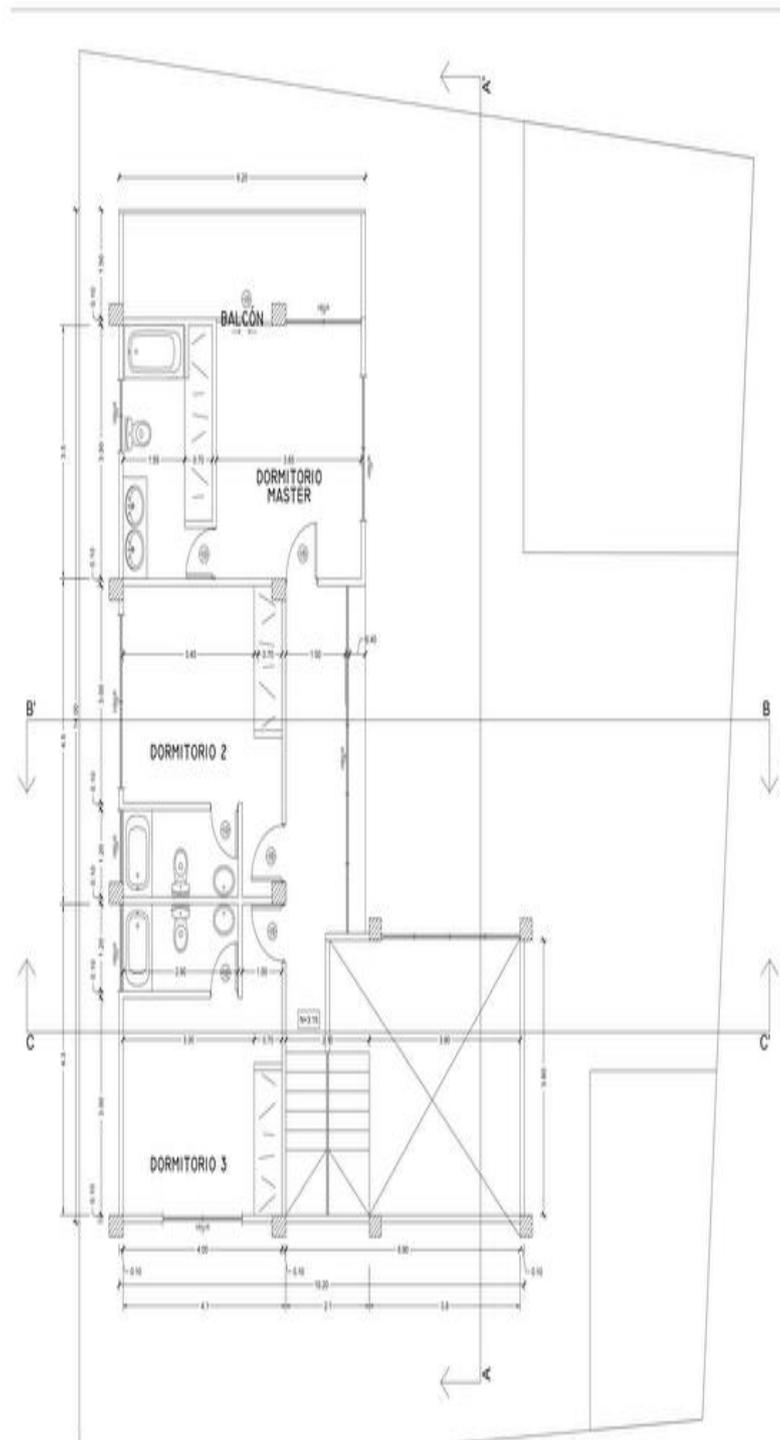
Planos de Proyecto. 2017. Fuente: Tutor de Trabajo de Grado
